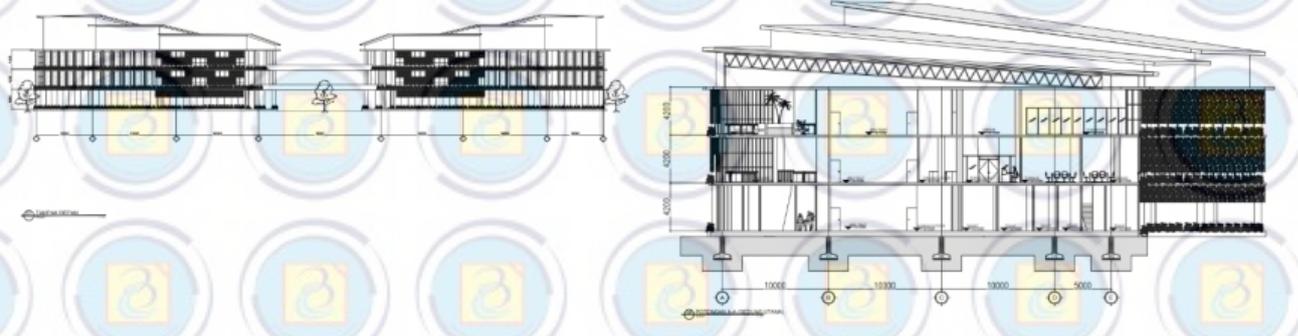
3 tampak depan, belakang, samping kanan dan kiri site
